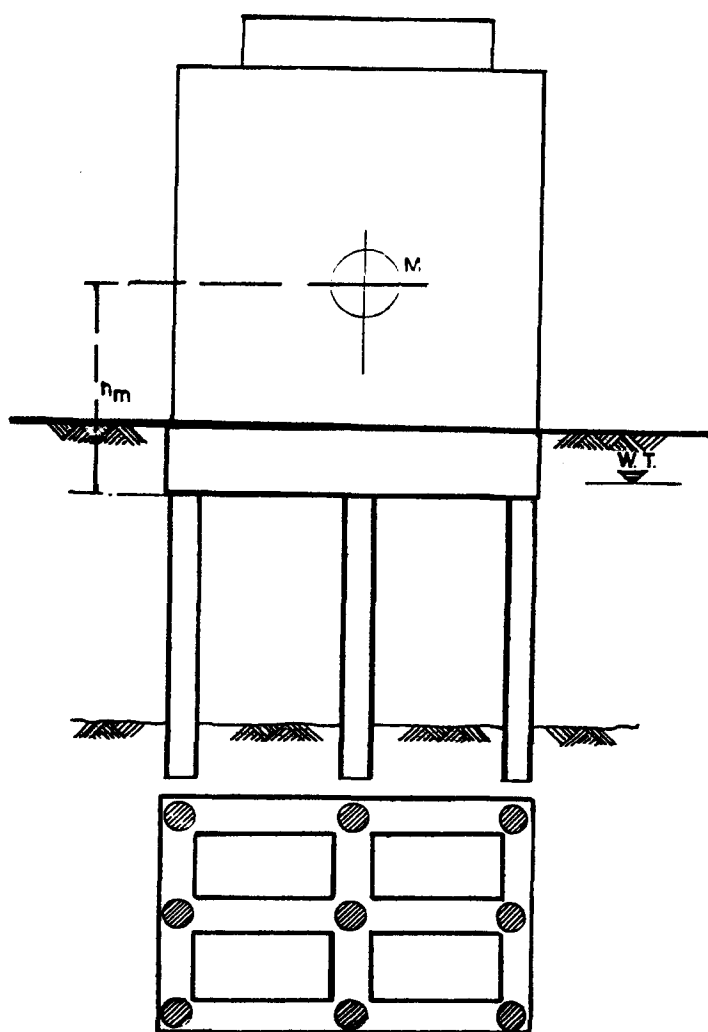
CIMENTACION RIGIDA DE UN EDIFICIO SOBRE PILAS
